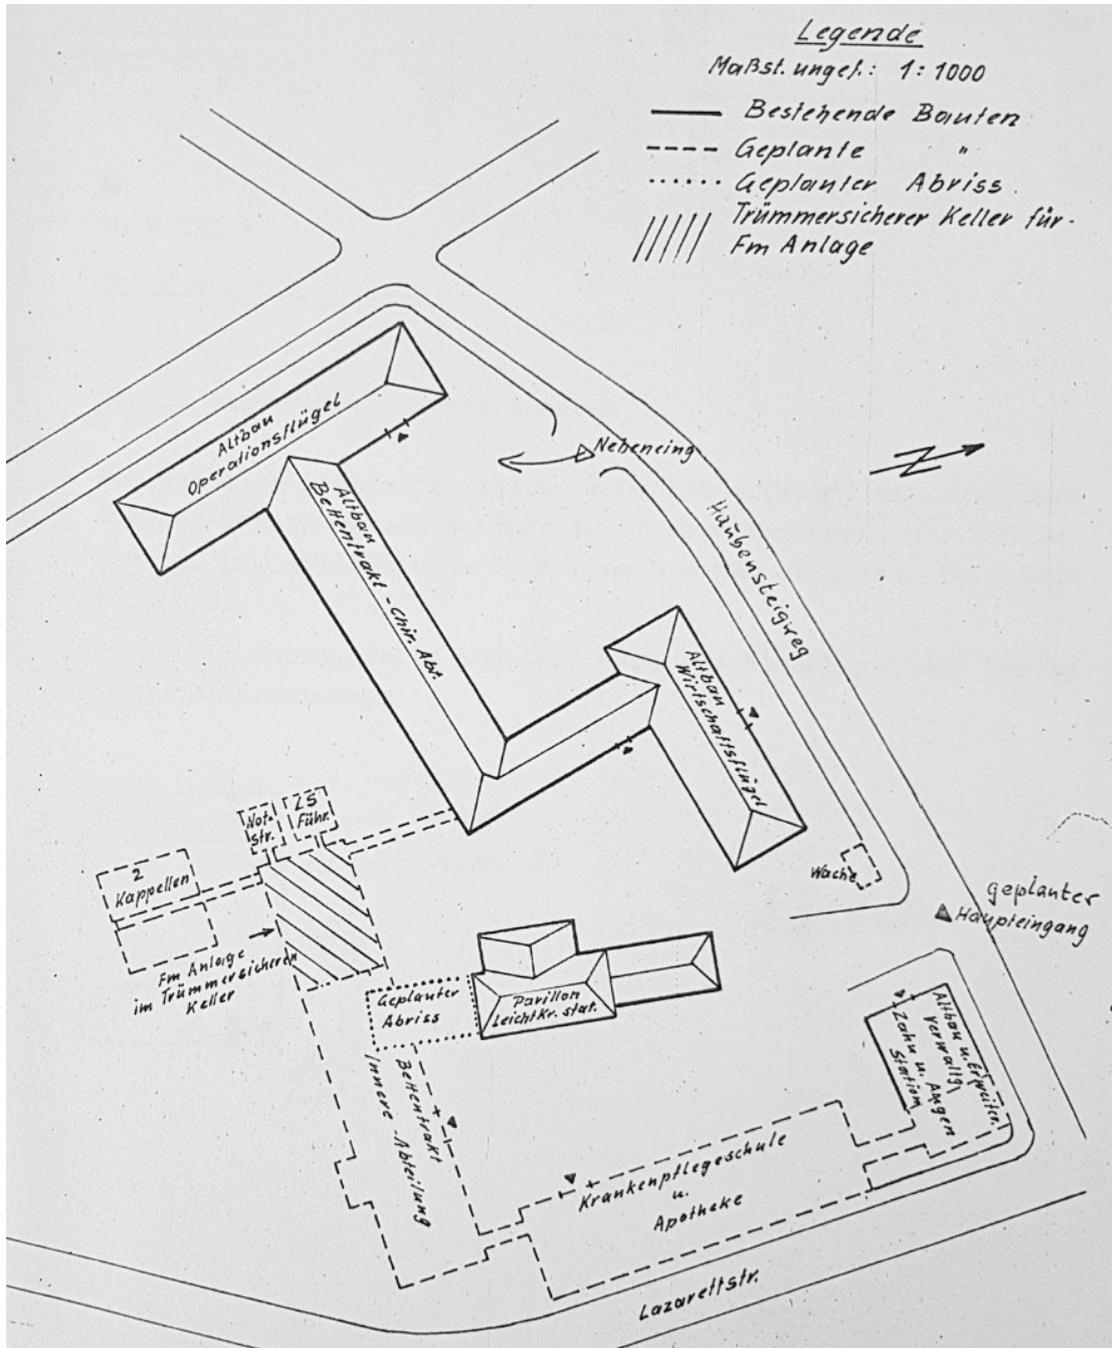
Skizzierter Lageplan zu Baumaßnahmen am BwLaz Kempten
